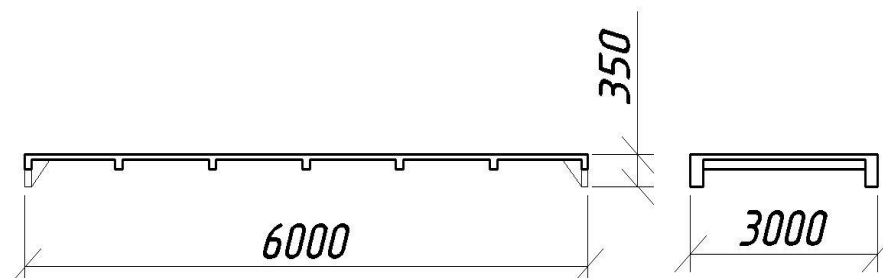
Схема ребристої залізобетонної плити покриття ПП1
